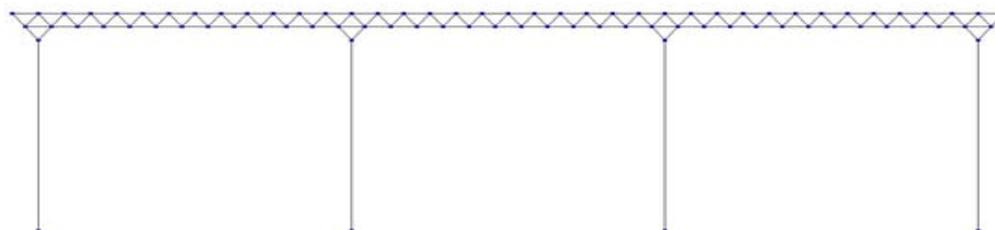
Проекция расчетной схемы покрытия «БрГТУ» на ось ZOY.
